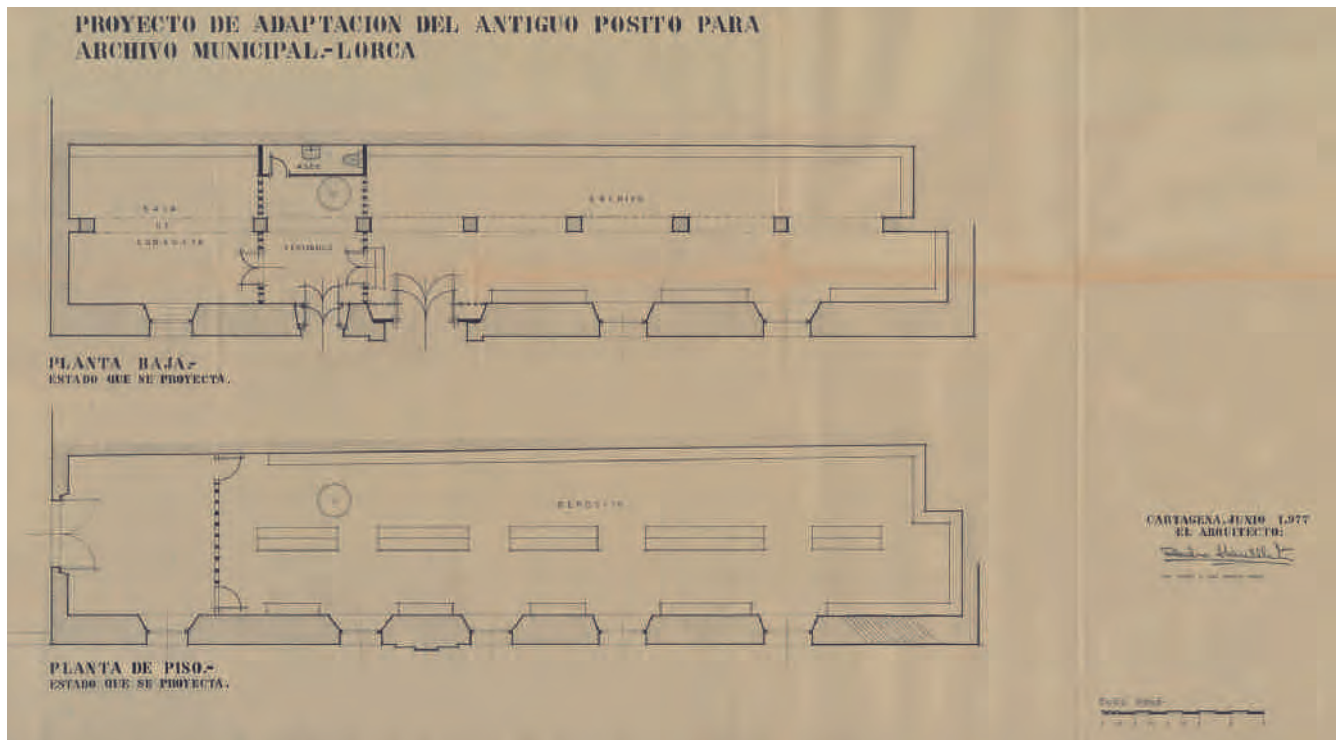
Plantas de propuesta del proyecto de adaptación para Archivo Municipal. ARM. P. San Martín Moro. 1
